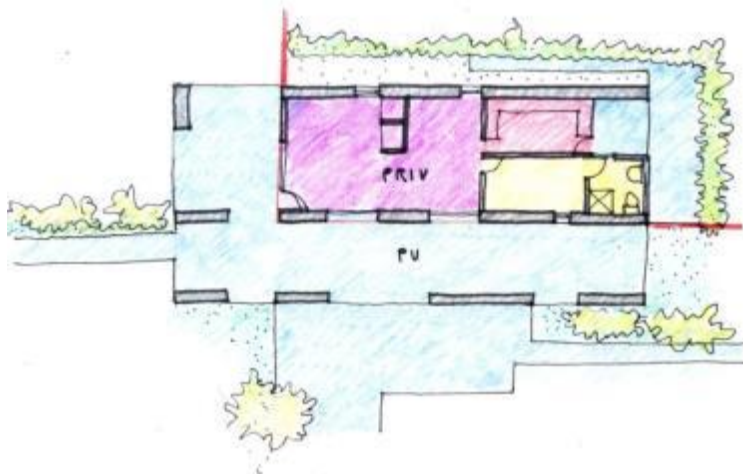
Planta Weekend House. Croquis realizado por el autor.
